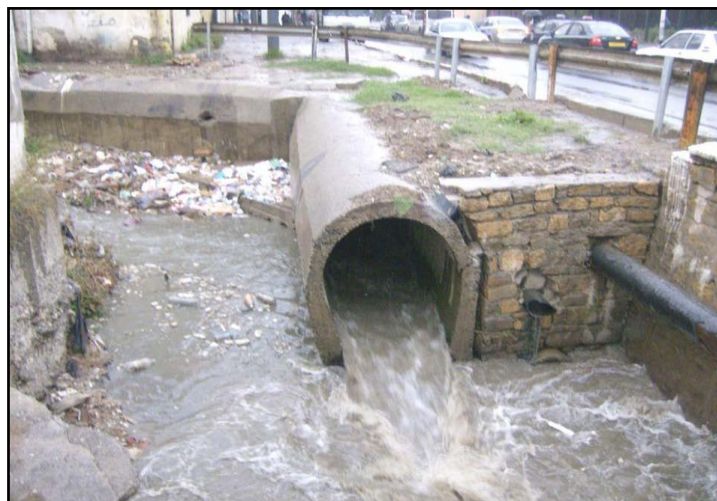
Rejet du collecteur (Ovoïde 1600-1200) dans l'oued Ouchaiah
